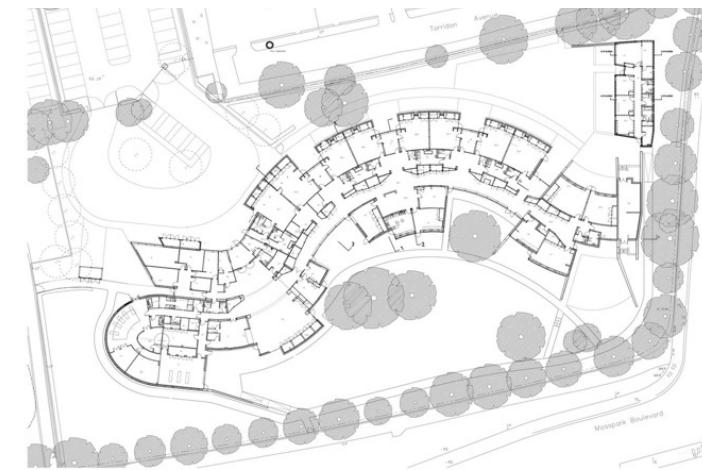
Fuente Architizer. Planta arquitectónica. Hazelwood School.
